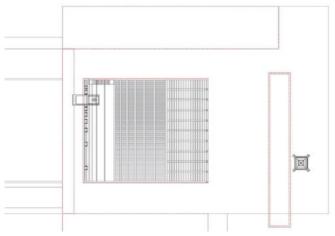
C. Planta de trama pavimentos, Plaza Alta. Fuente: elaboración propia.
